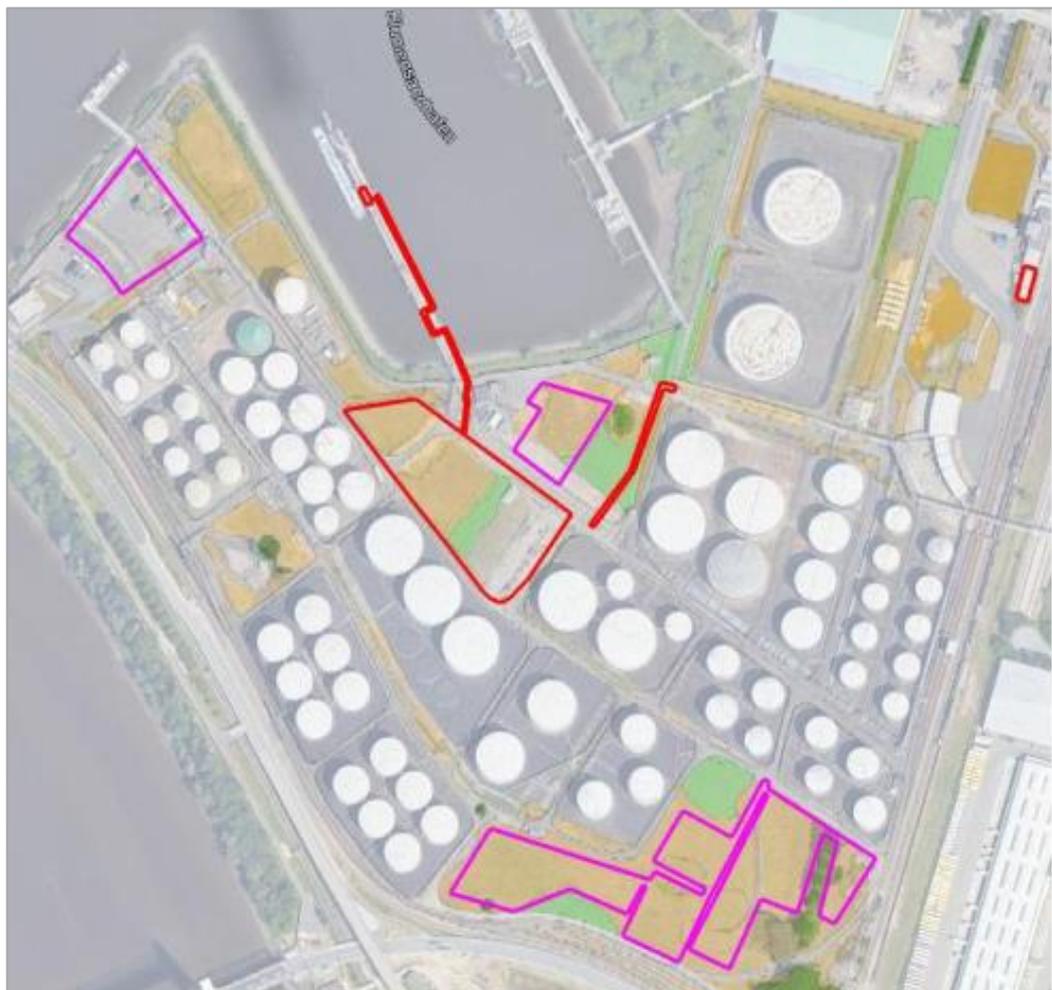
Lage der BE-Flächen (violette Markierung) und der anlagenbedingt beanspruchten Fläche (rote Markierung). Darstellung entnommen aus dem LBP der Firma PlanB [18].
